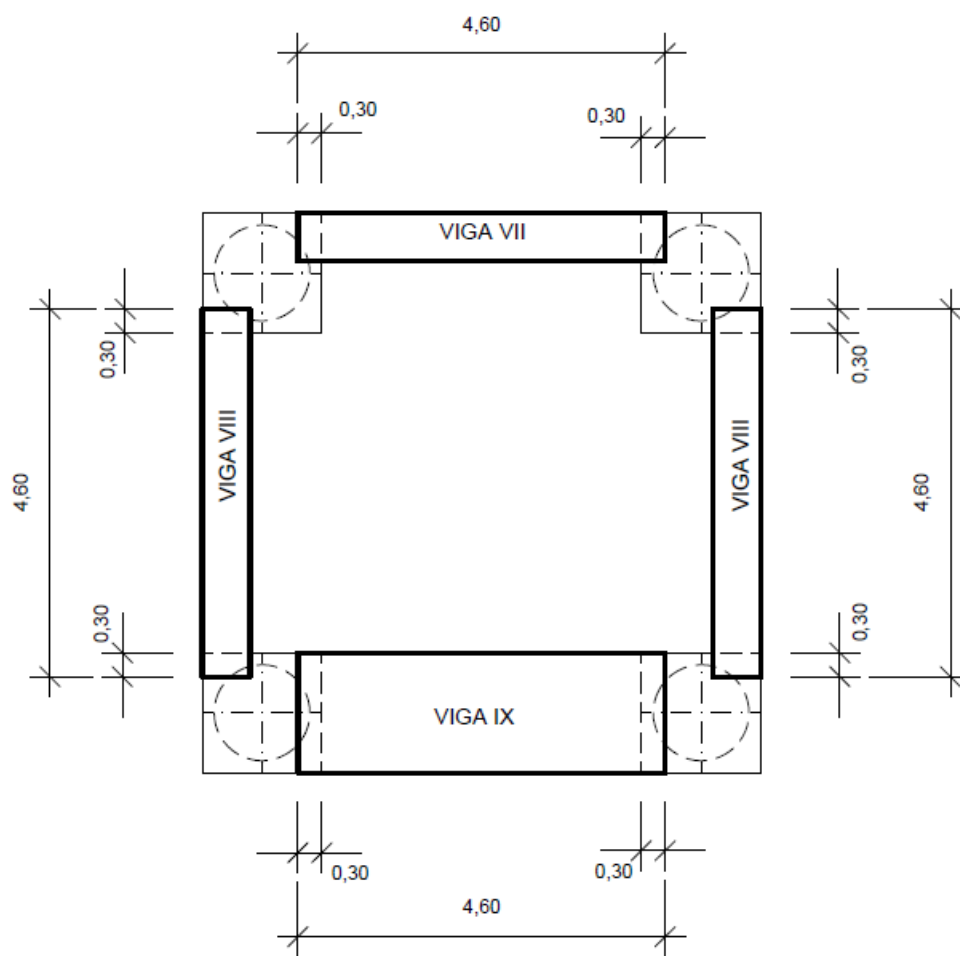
Disposición de las vigas prefabricadas sobre capiteles.
